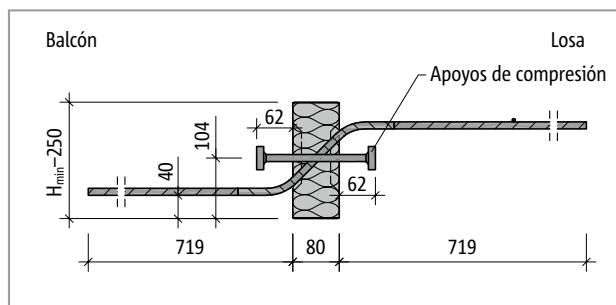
Schöck Isokorb® T tipo Q-P con R0: Sección del producto
